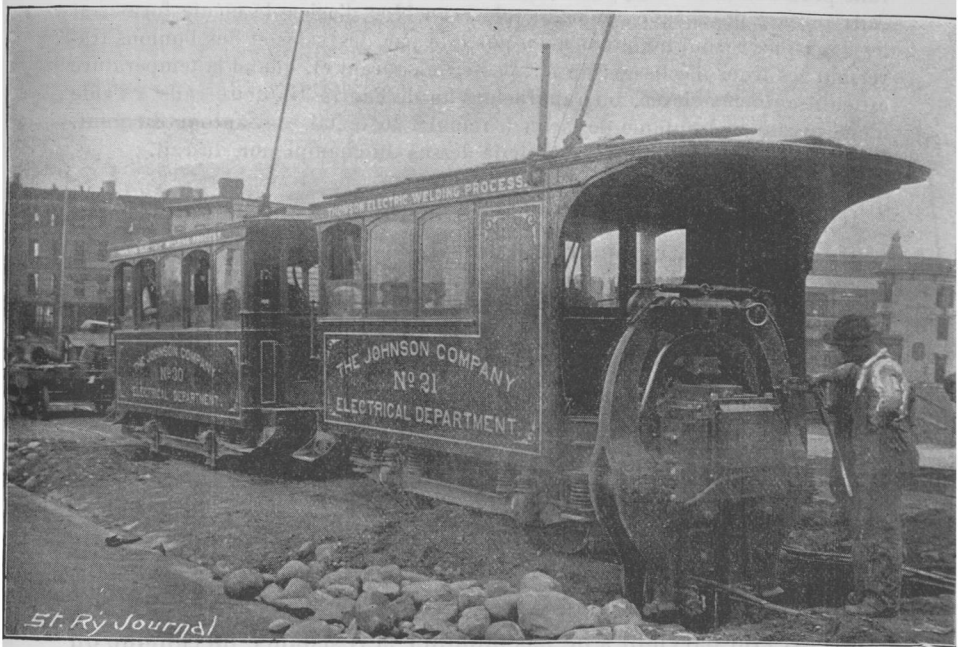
Matériel de soudure électrique des rails employé à Brooklyn.
